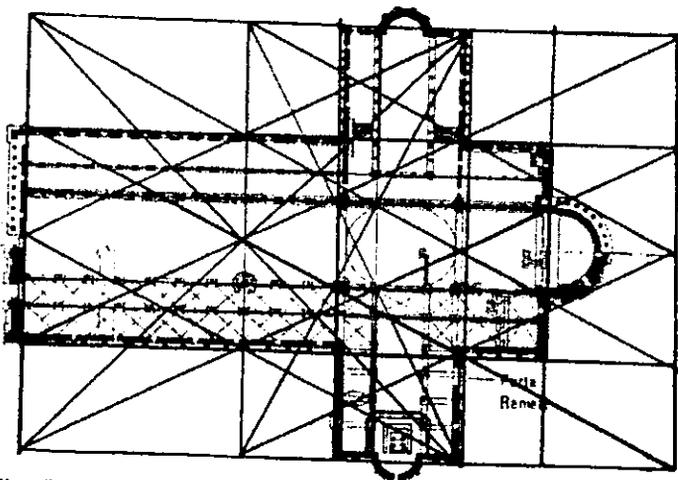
Trazo de la planta de la Catedral de Pisa.
